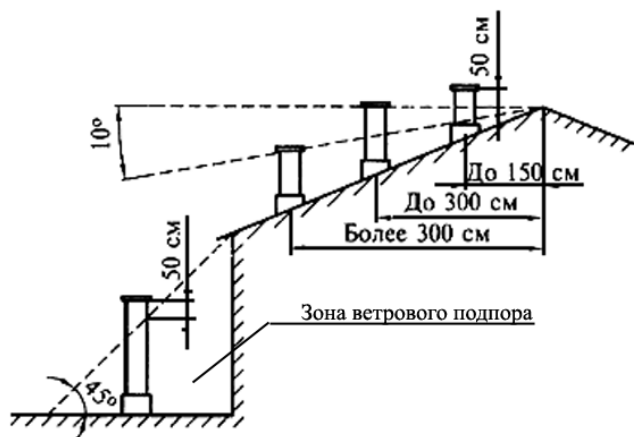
Схема определения отметки устья вентиляционных каналов на крыше здания
